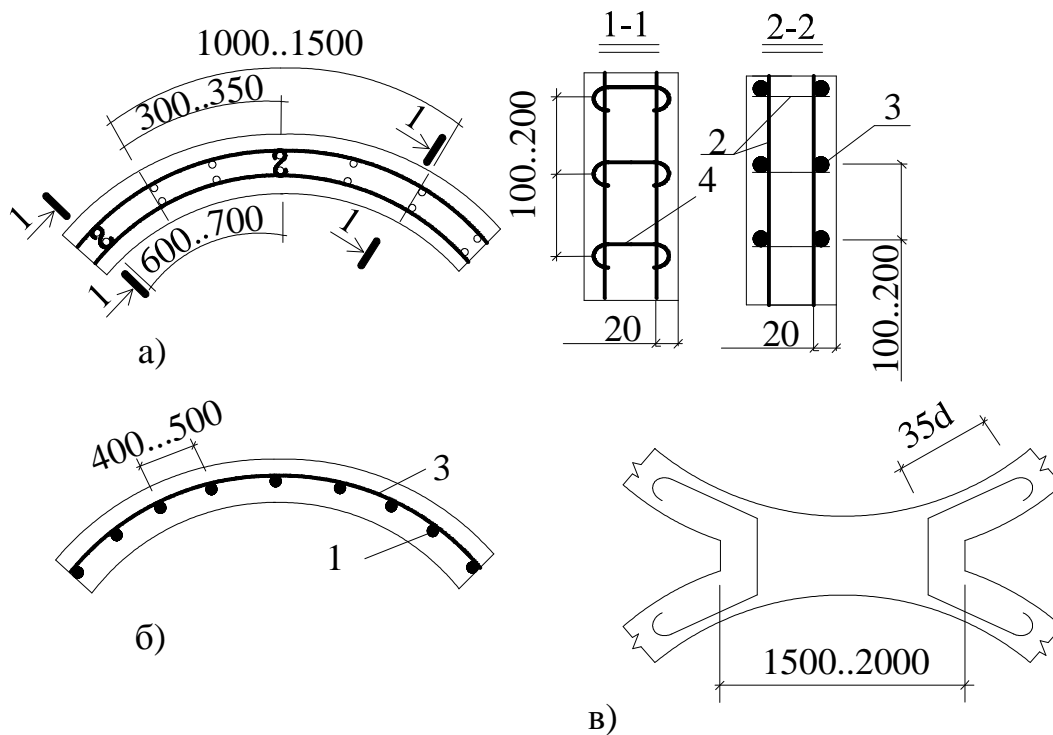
Схема армування циліндричних монолітних силосів:
